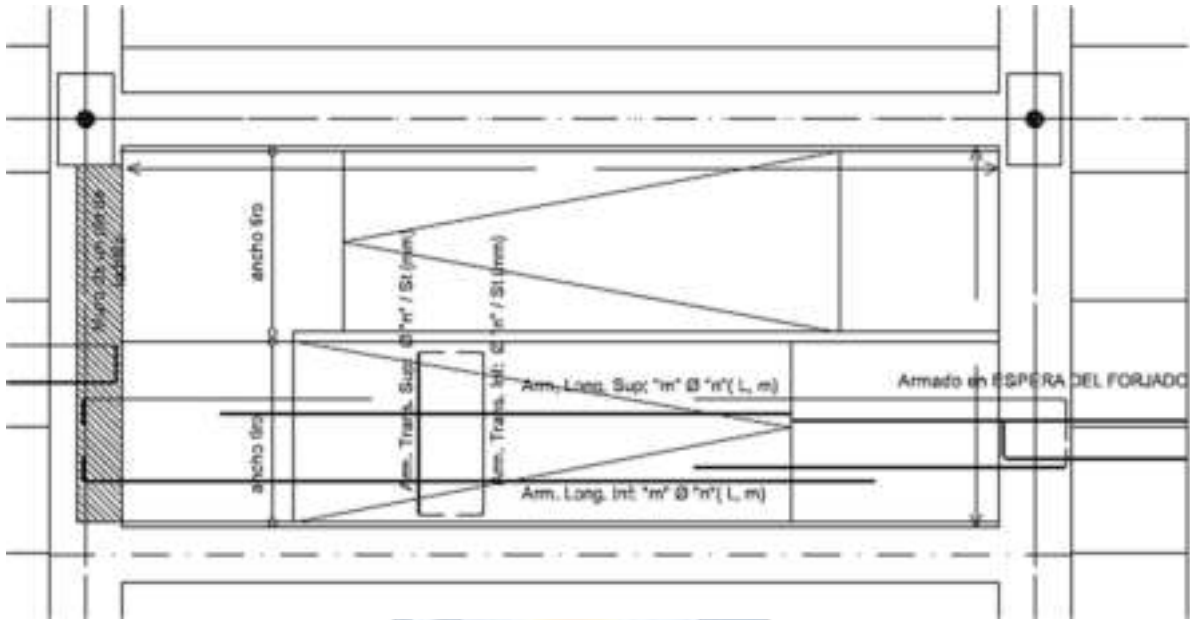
Detalle de la armadura de una escalera típica vista en planta
